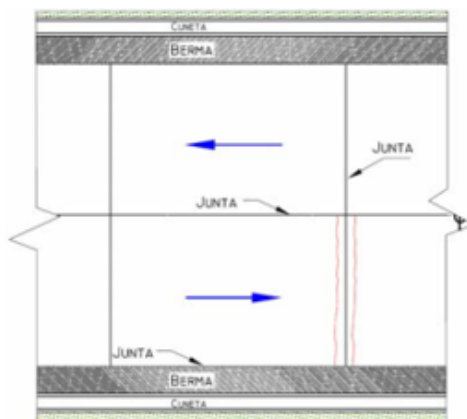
Características de las grietas en los extremos de los pasadores (INVIAS, 2006)
